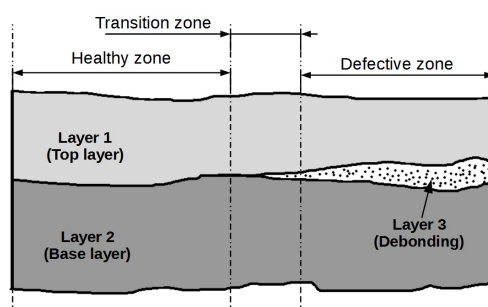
Schéma simplifié d'un décollement entre couches de chaussée
